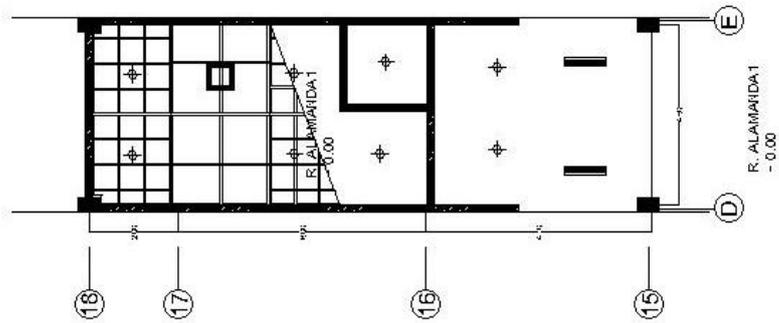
Rencana lantai *layout* ruang terpilih
